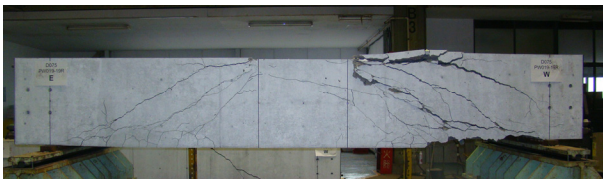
実験終了後のひびわれ状況 (D075PW019-19)
